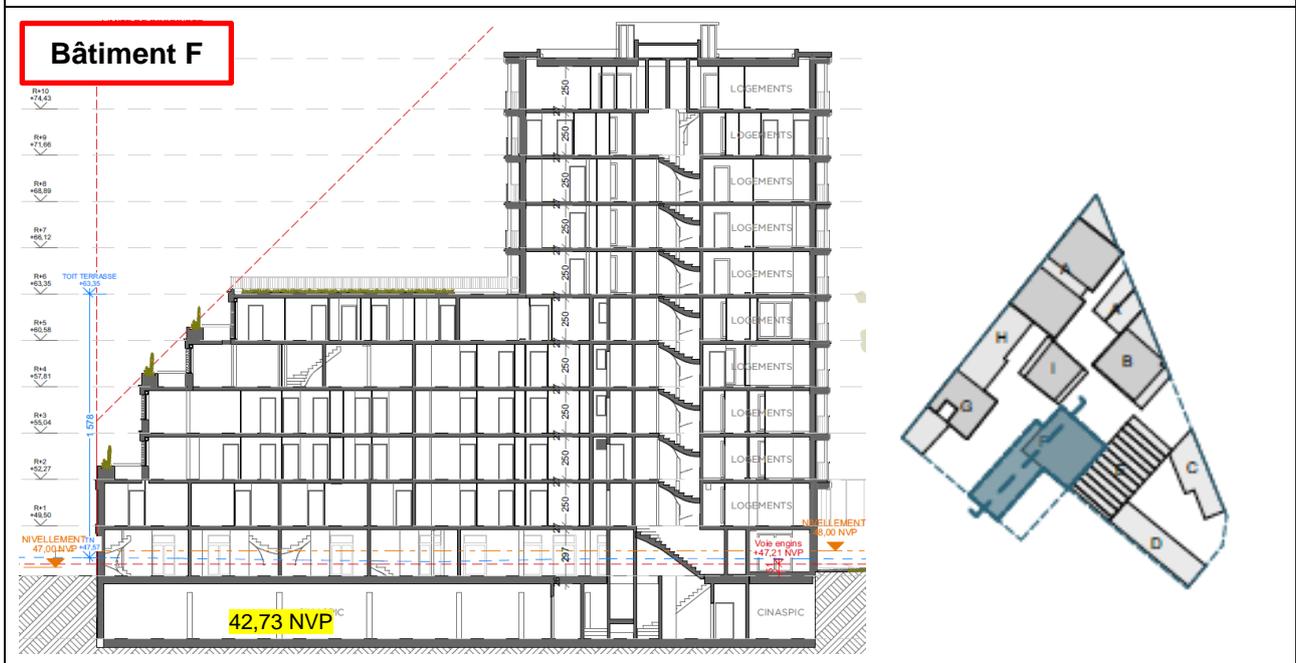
Extrait du plan de coupe du bâtiment F, datés du 16/11/2023
